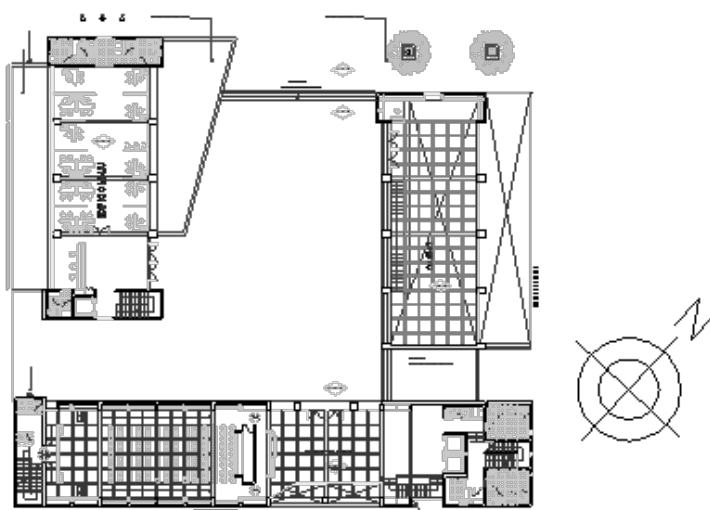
Planta Piso 1 – Acceso – Nivel 0,00
